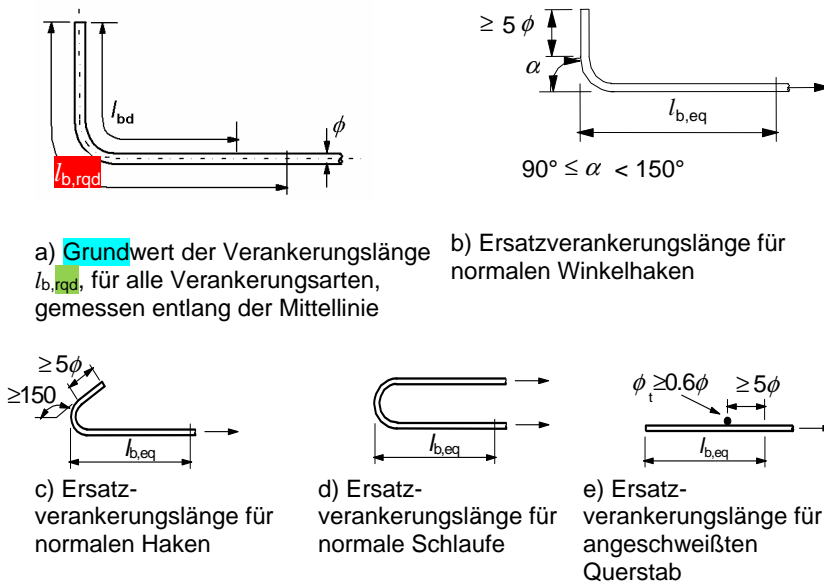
Zusätzliche Verankerungsarten zum geraden Stab
